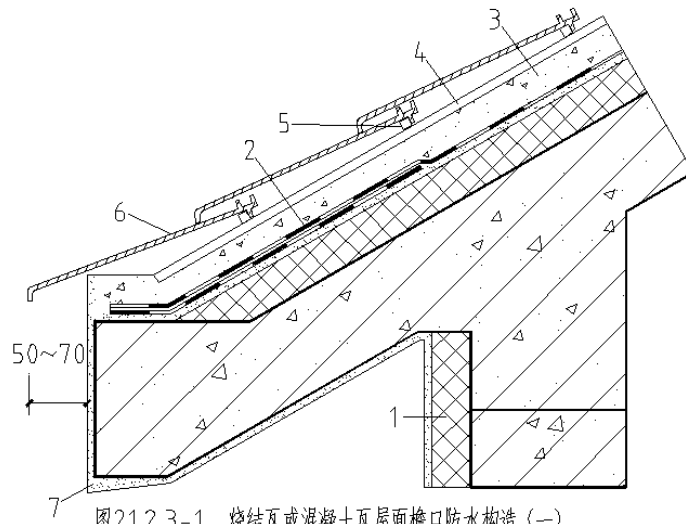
烧结瓦或混凝土瓦屋面檐口防水构造(一)
